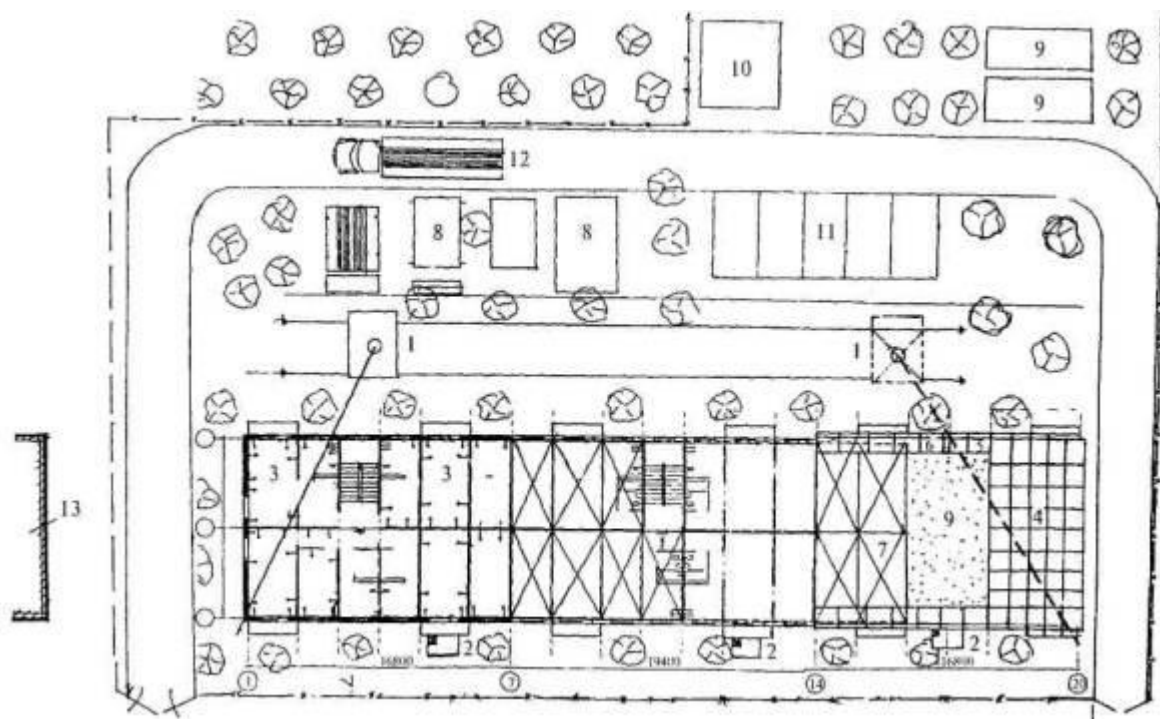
Фрагмент стройгенплана на демонтаж крупнопанельного жилого дома
